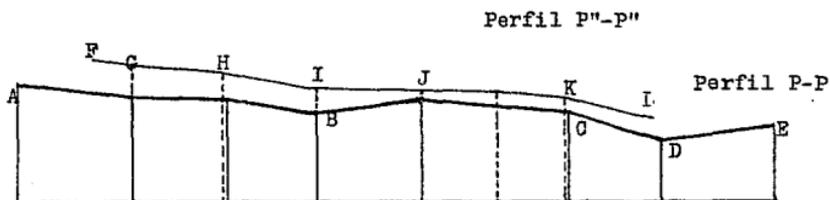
Doble perfil longitudinal en un tramo de línea
